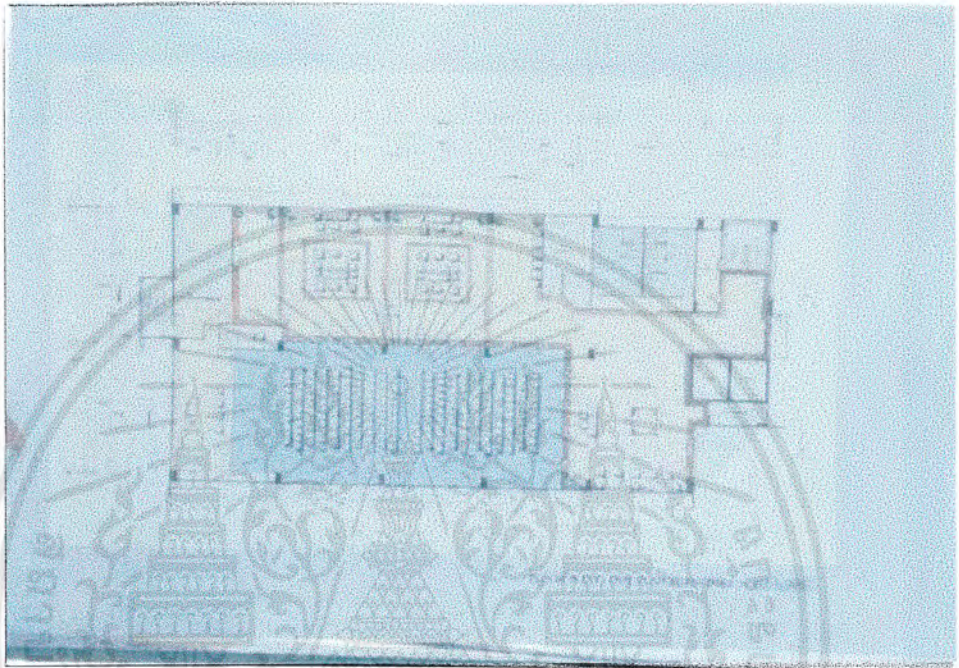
แสดง FLOOR 2 LAY-OUT FURNITURE PLAN
